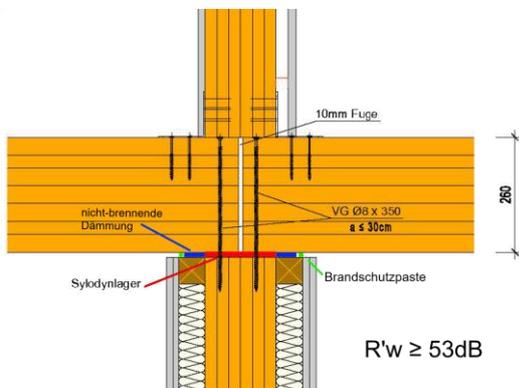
Deckenanschluss Wohnungstrennwand [B. Walter Ingenieurgesell. mbH]
